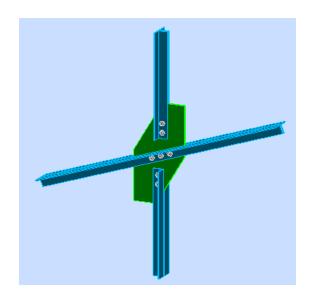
Vue en 3D d'assemblage contreventement verticale
